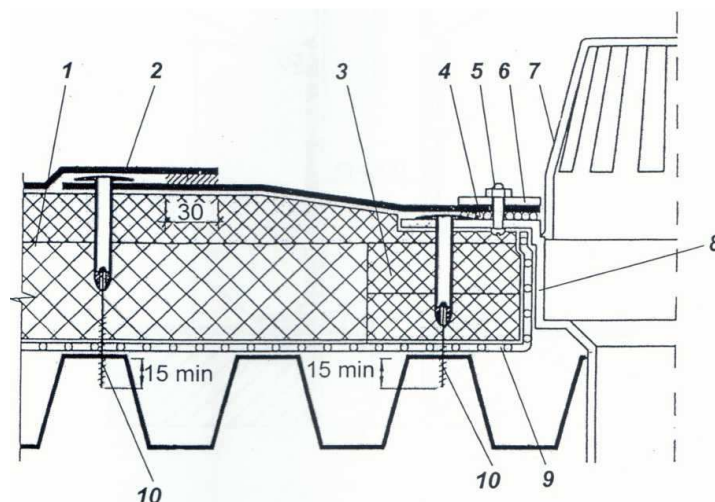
Схема устройства примыкания гидроизоляционного ковра из полимерных мембран к воронкам внутреннего водостока
